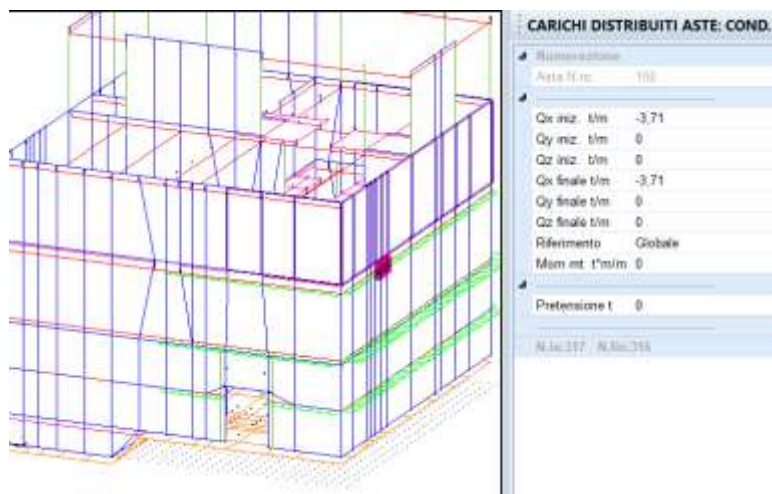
Assegnazione incremento della spinta del terreno per sovraccarico sul perimetro piazzale
